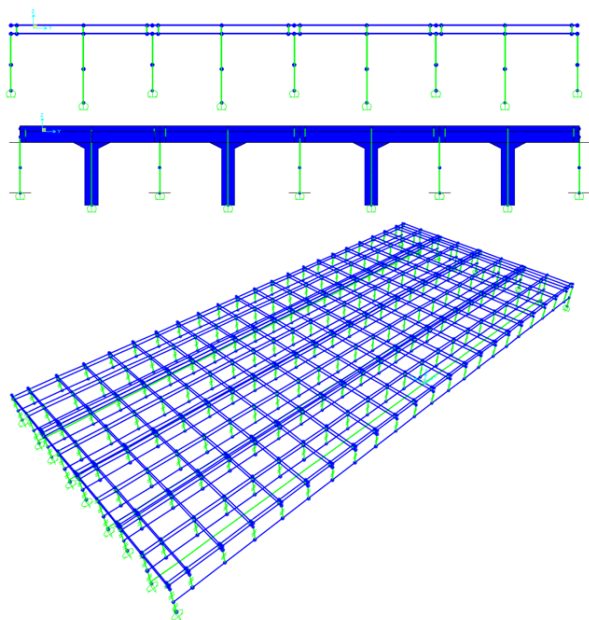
Modelo de cálculo tipo para refuerzo de vigas pi
